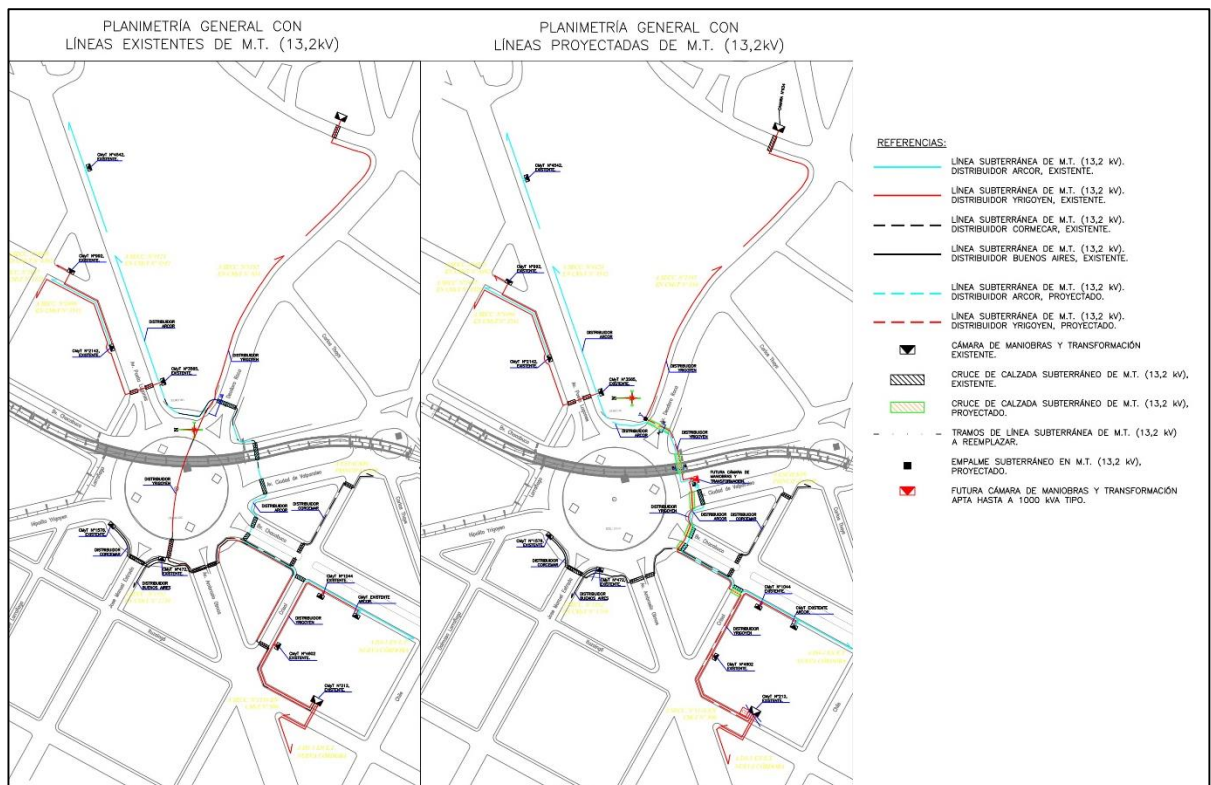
Planimetría general con líneas de media tensión existentes y proyectadas. (PLANO N° 20)
